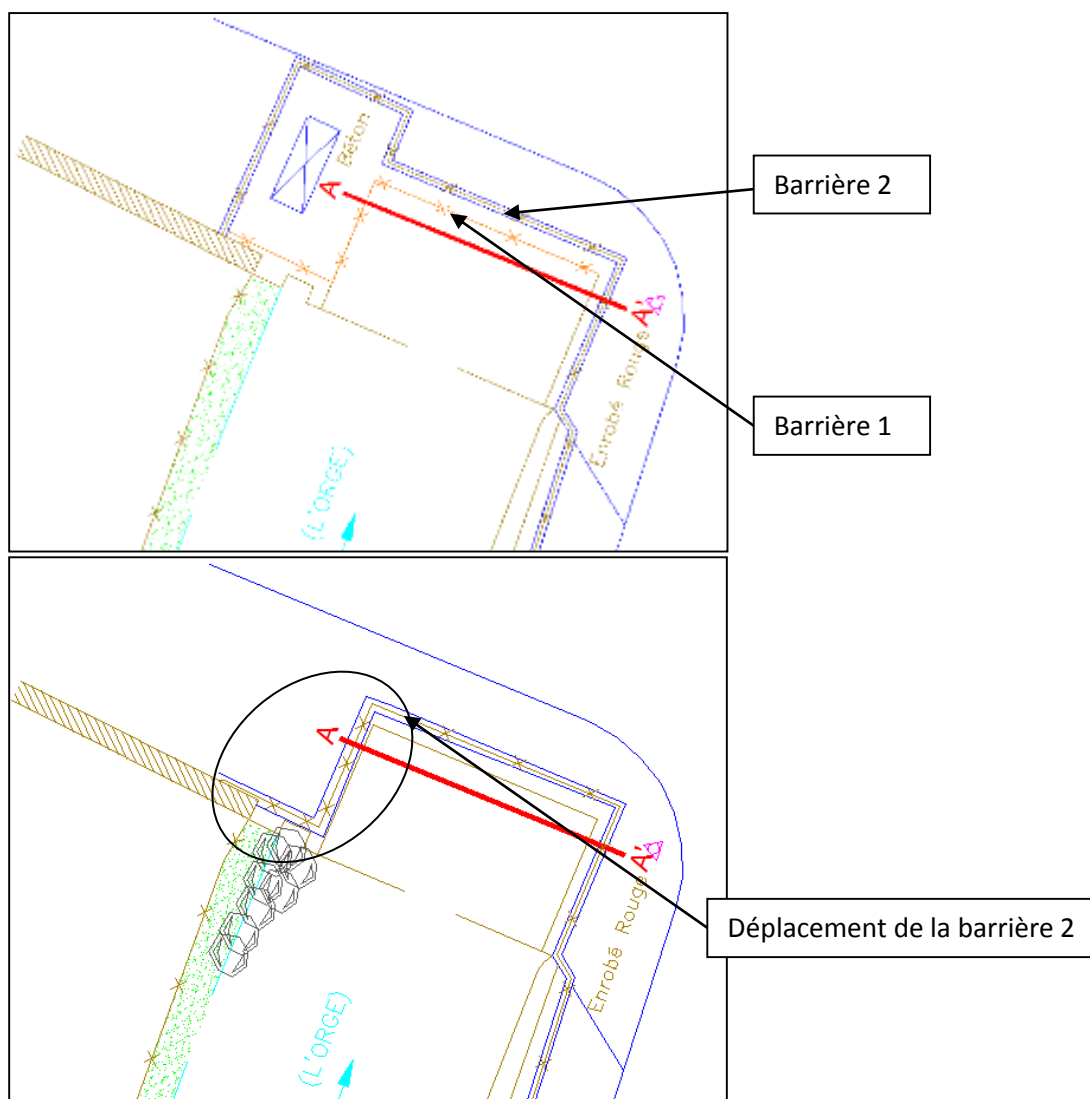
Travaux de modification des barrières, en haut : état initial ; en bas : état projet.
